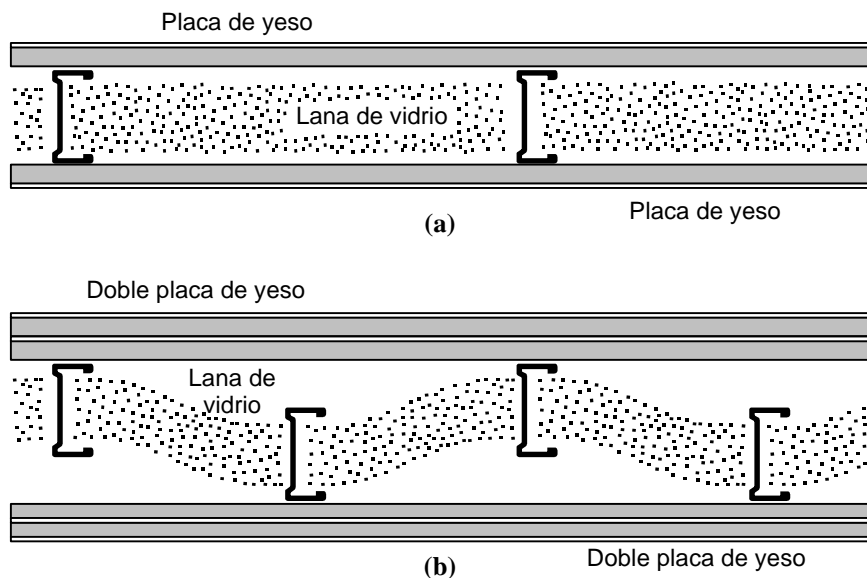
(a) Vista superior en corte de un montaje de placas de roca de yeso con estructura formada por perfiles de chapa. (b) Estructura alternada sin conexión rígida. Notar la diferencia de espesores a uno y otro lado de la pared.
